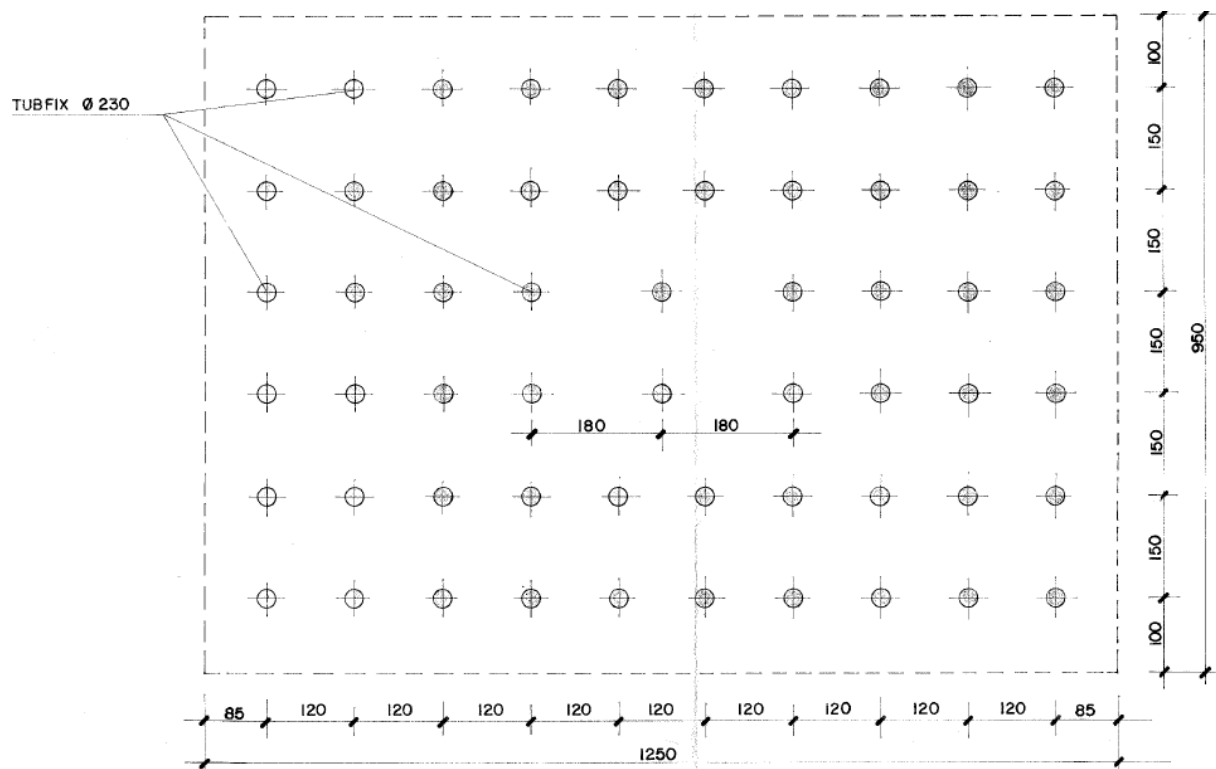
Pianta pila P16 su fondazione diretta con n°58 micropali
